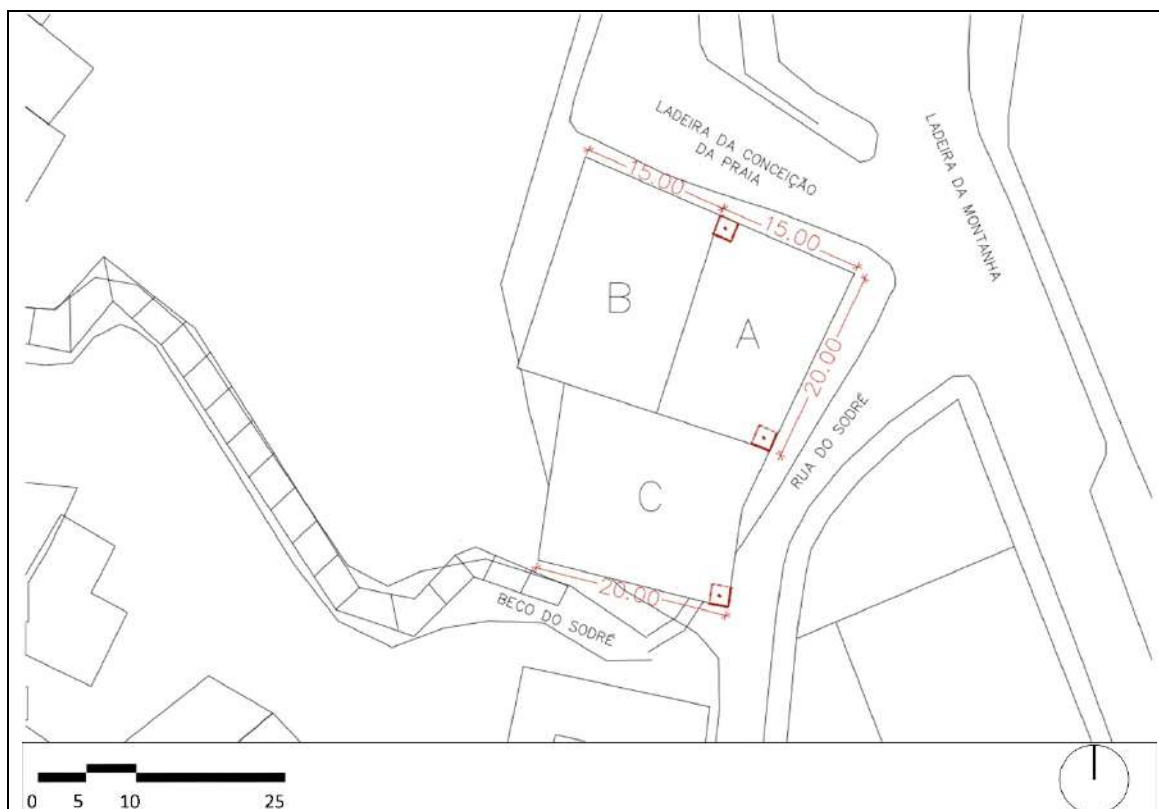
Planta geral do TRS, com a indicação dos Blocos A, B e C [Fonte: elaborado pela equipe Normas CHS]
